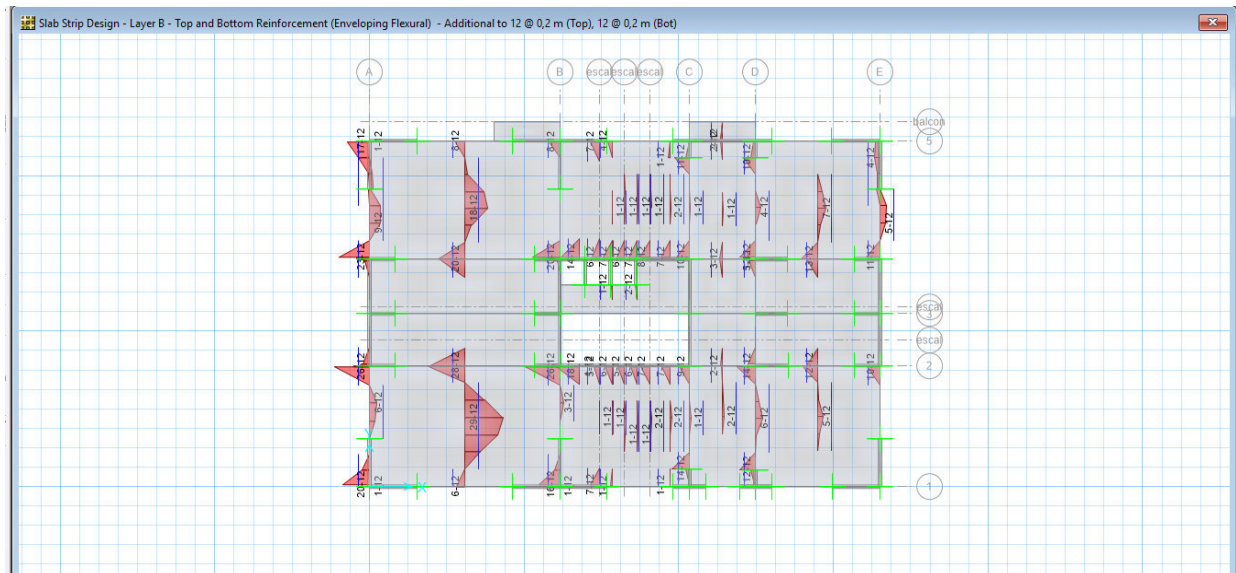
Schéma de déformation de ferrailage du Plancher Haut Sous /Sol au niveau des Appuis et Travées - Directions Axe (Y-Y)
